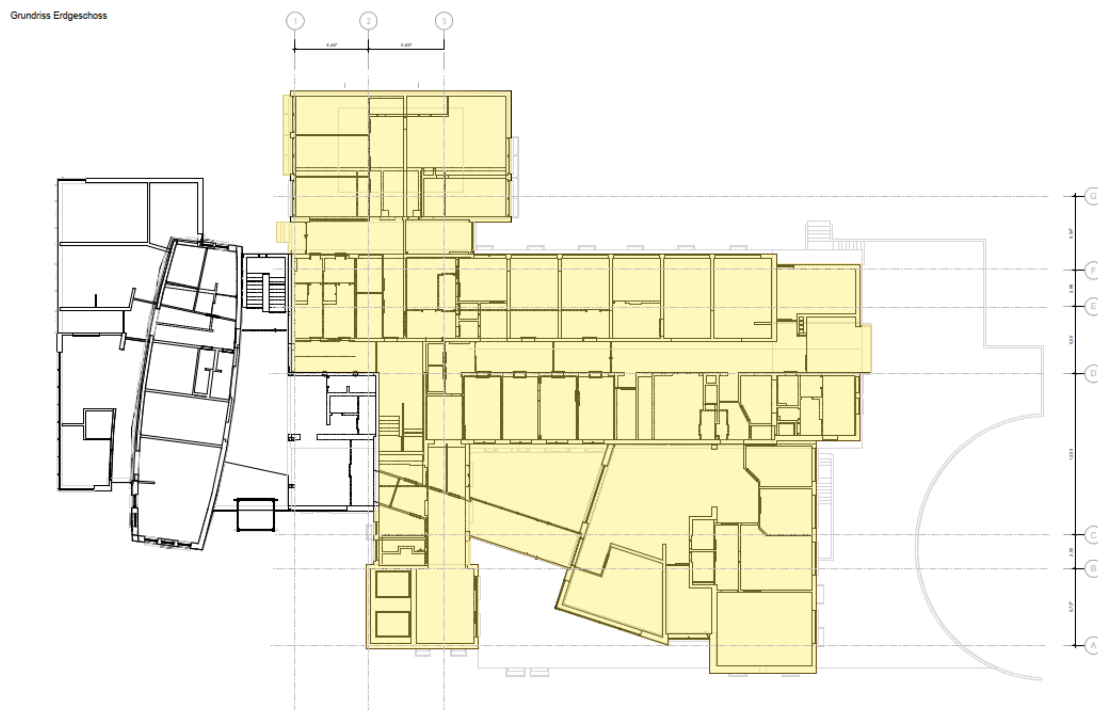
Grundriss EG mit Kennzeichnung Abbruch (gelb) und Bestand (grau)
